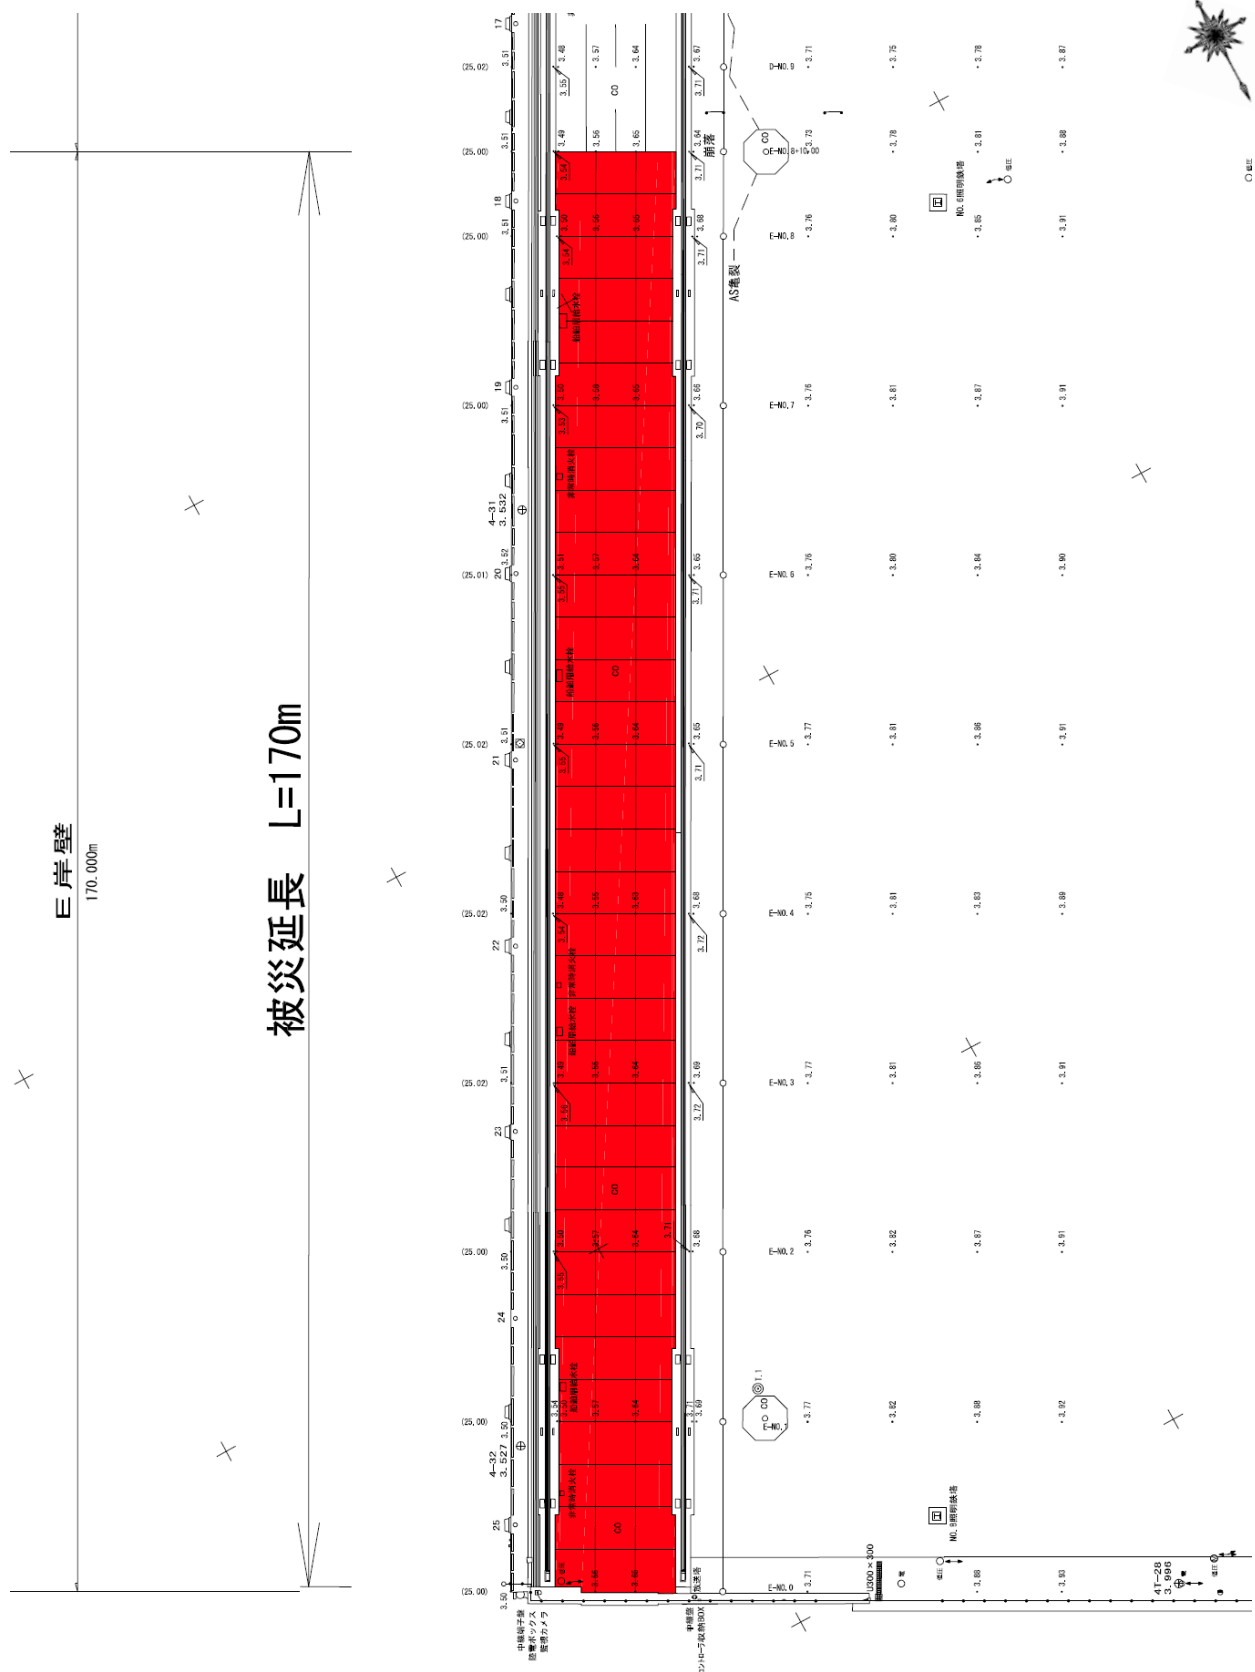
No.7 北公共埠頭地区C・D・E岸壁（-10m）の平面図（E岸壁）（被災後）
